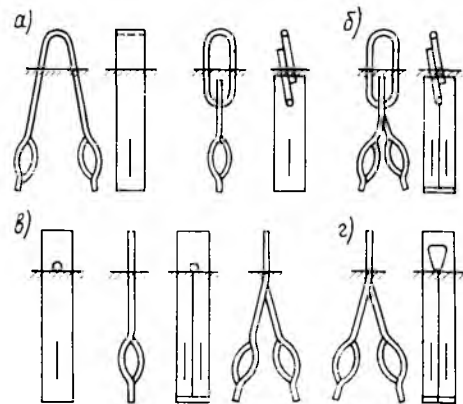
Штампованные строповочные детали, рассчитанные на подъем универсальными (стандартными) захватными устройствами
